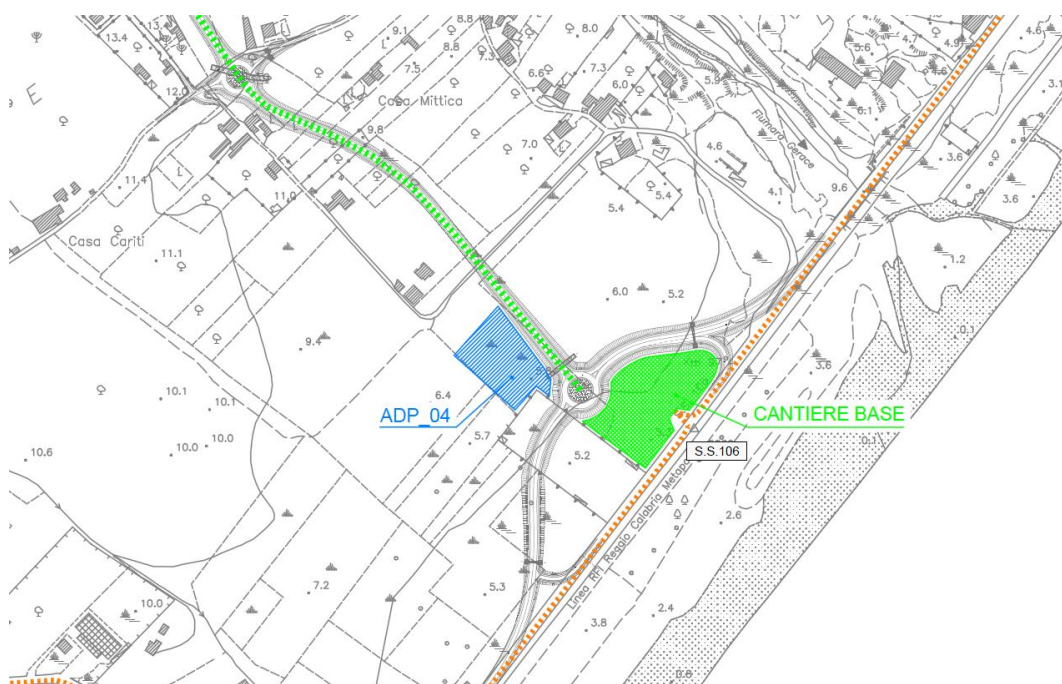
Area di deposito ADP_04 e Cantiere Base
